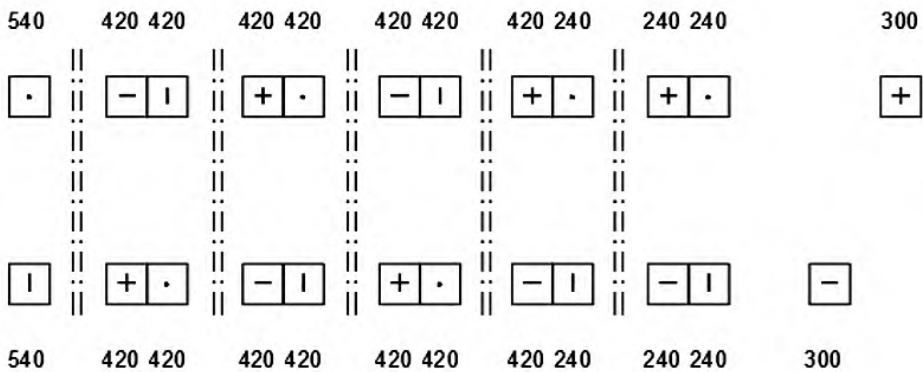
Disposizione in pianta degli appoggi e carichi massimi (t)
